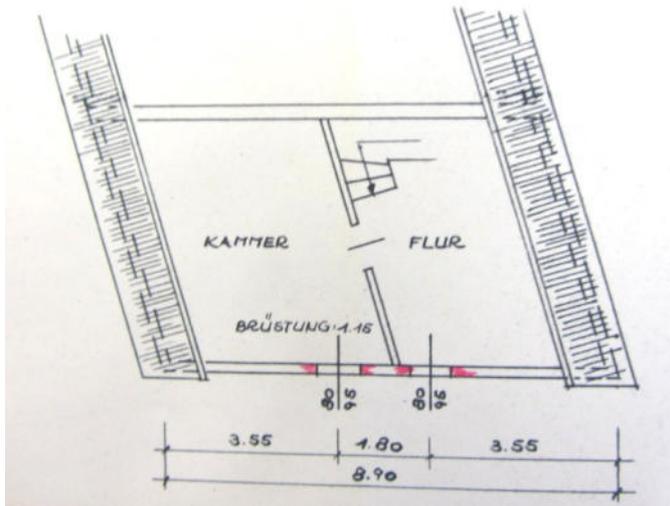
Grundriss Dachgeschoss Altbau
